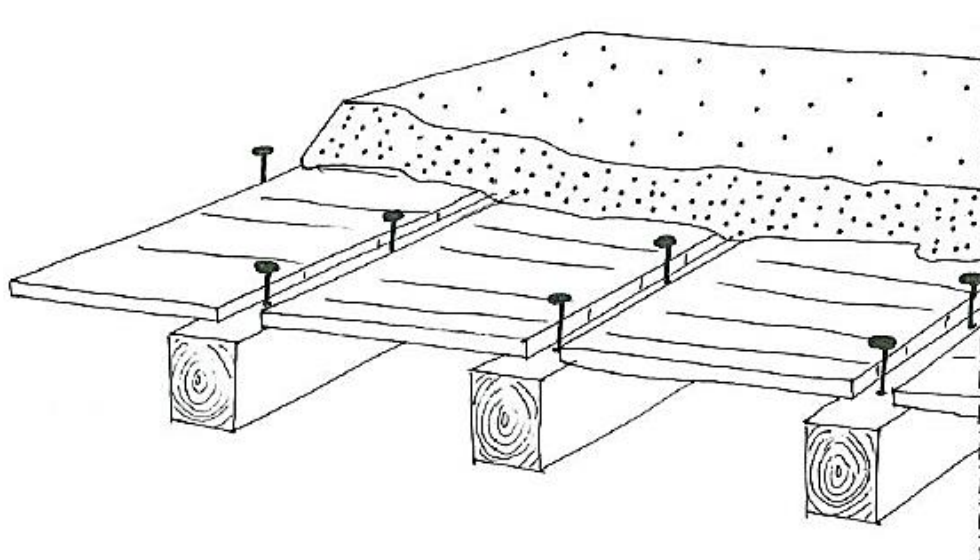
Lajeta de betão sobre pavimento de madeira [71]
